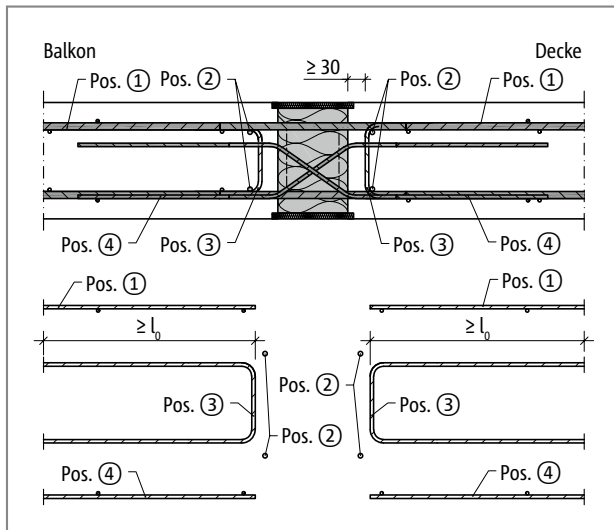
Schöck Isokorb® XT Typ DL: Bauseitige Armierung
